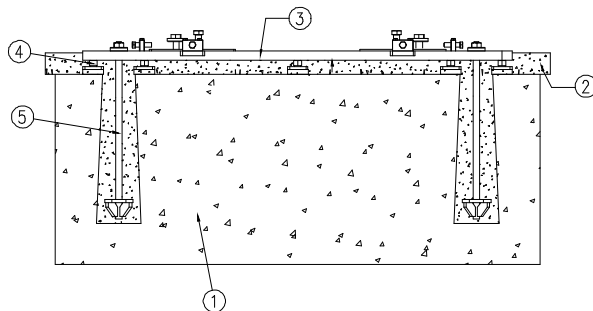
Ejemplo de fundación con fijación por placas de anclaje
